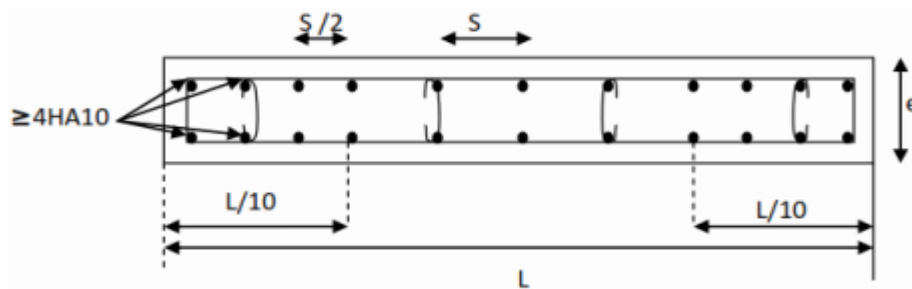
Disposition des armatures verticales dans les voiles.
